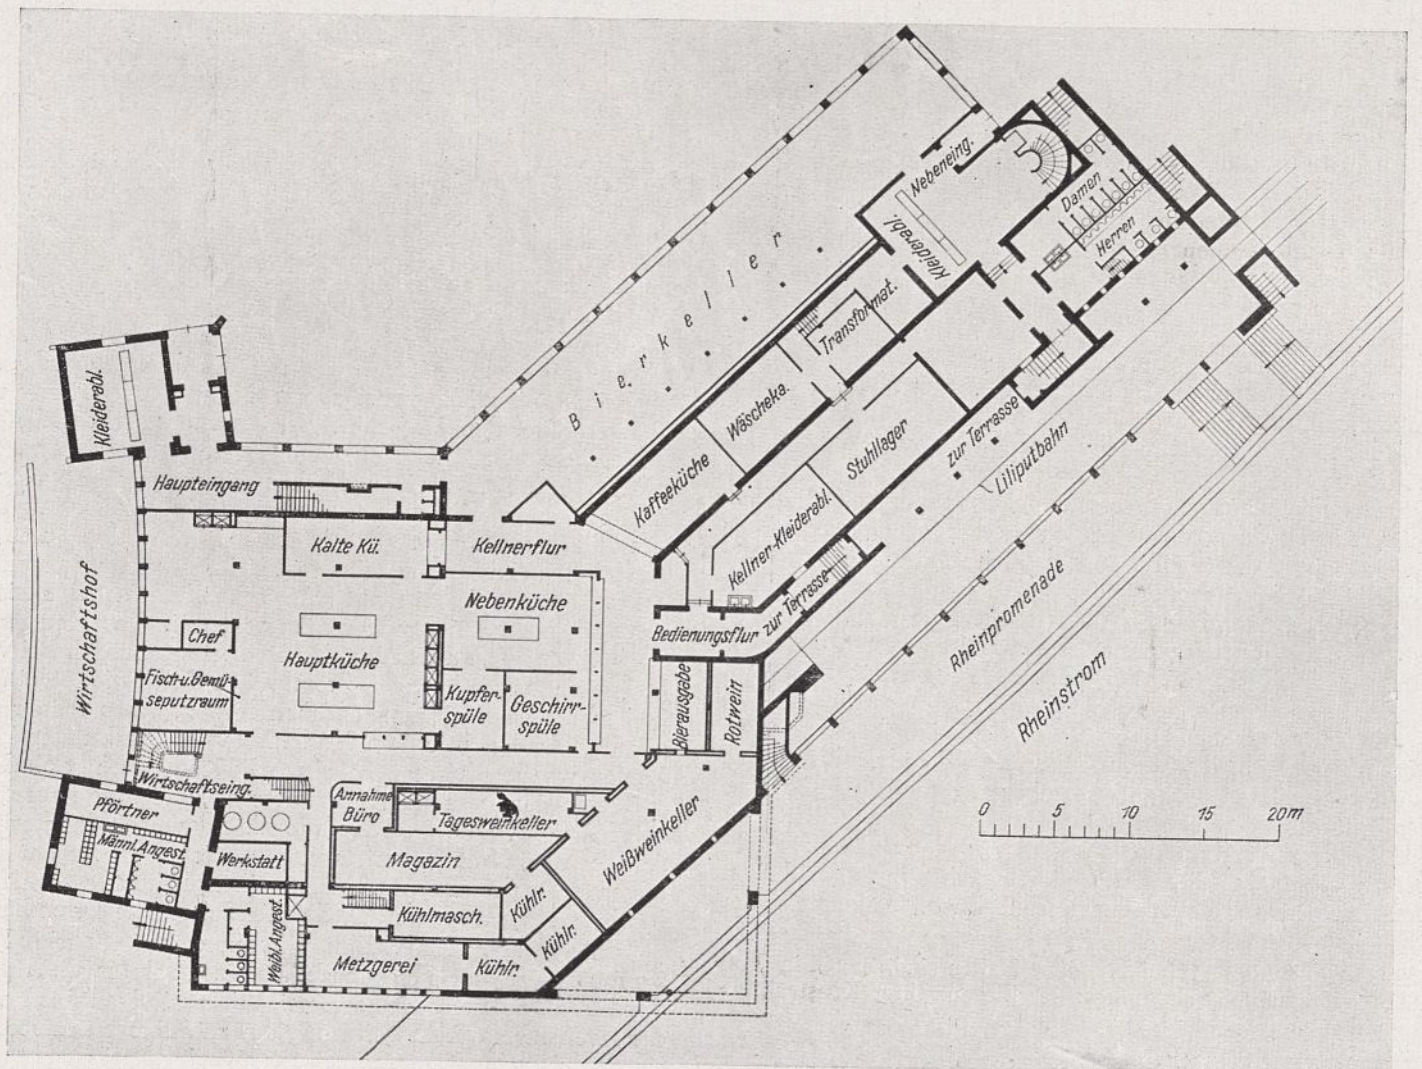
und 21. Rheingaststätte, Grundrisse des Erd- und Hauptgeschosses. M. 1 : 500.
